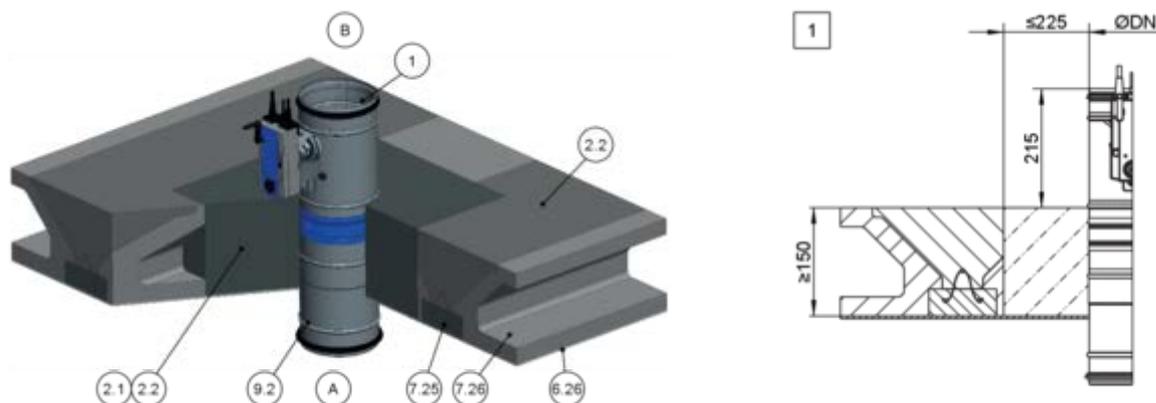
Montage au mortier avec socle en béton dans une dalle de plafond pleine, verticalement, occupation simultanée
